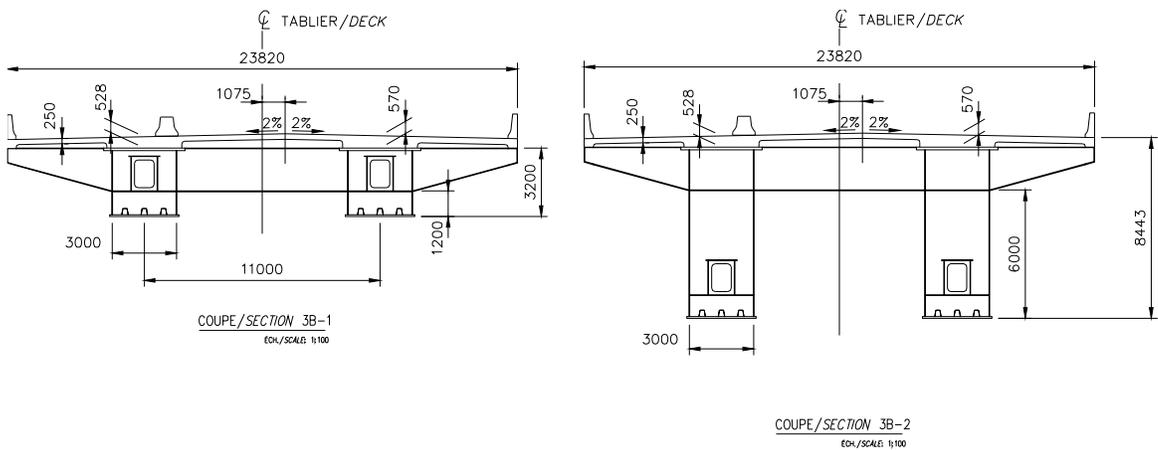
Coupes transversales – Pont en ossature mixte – bipoutre
